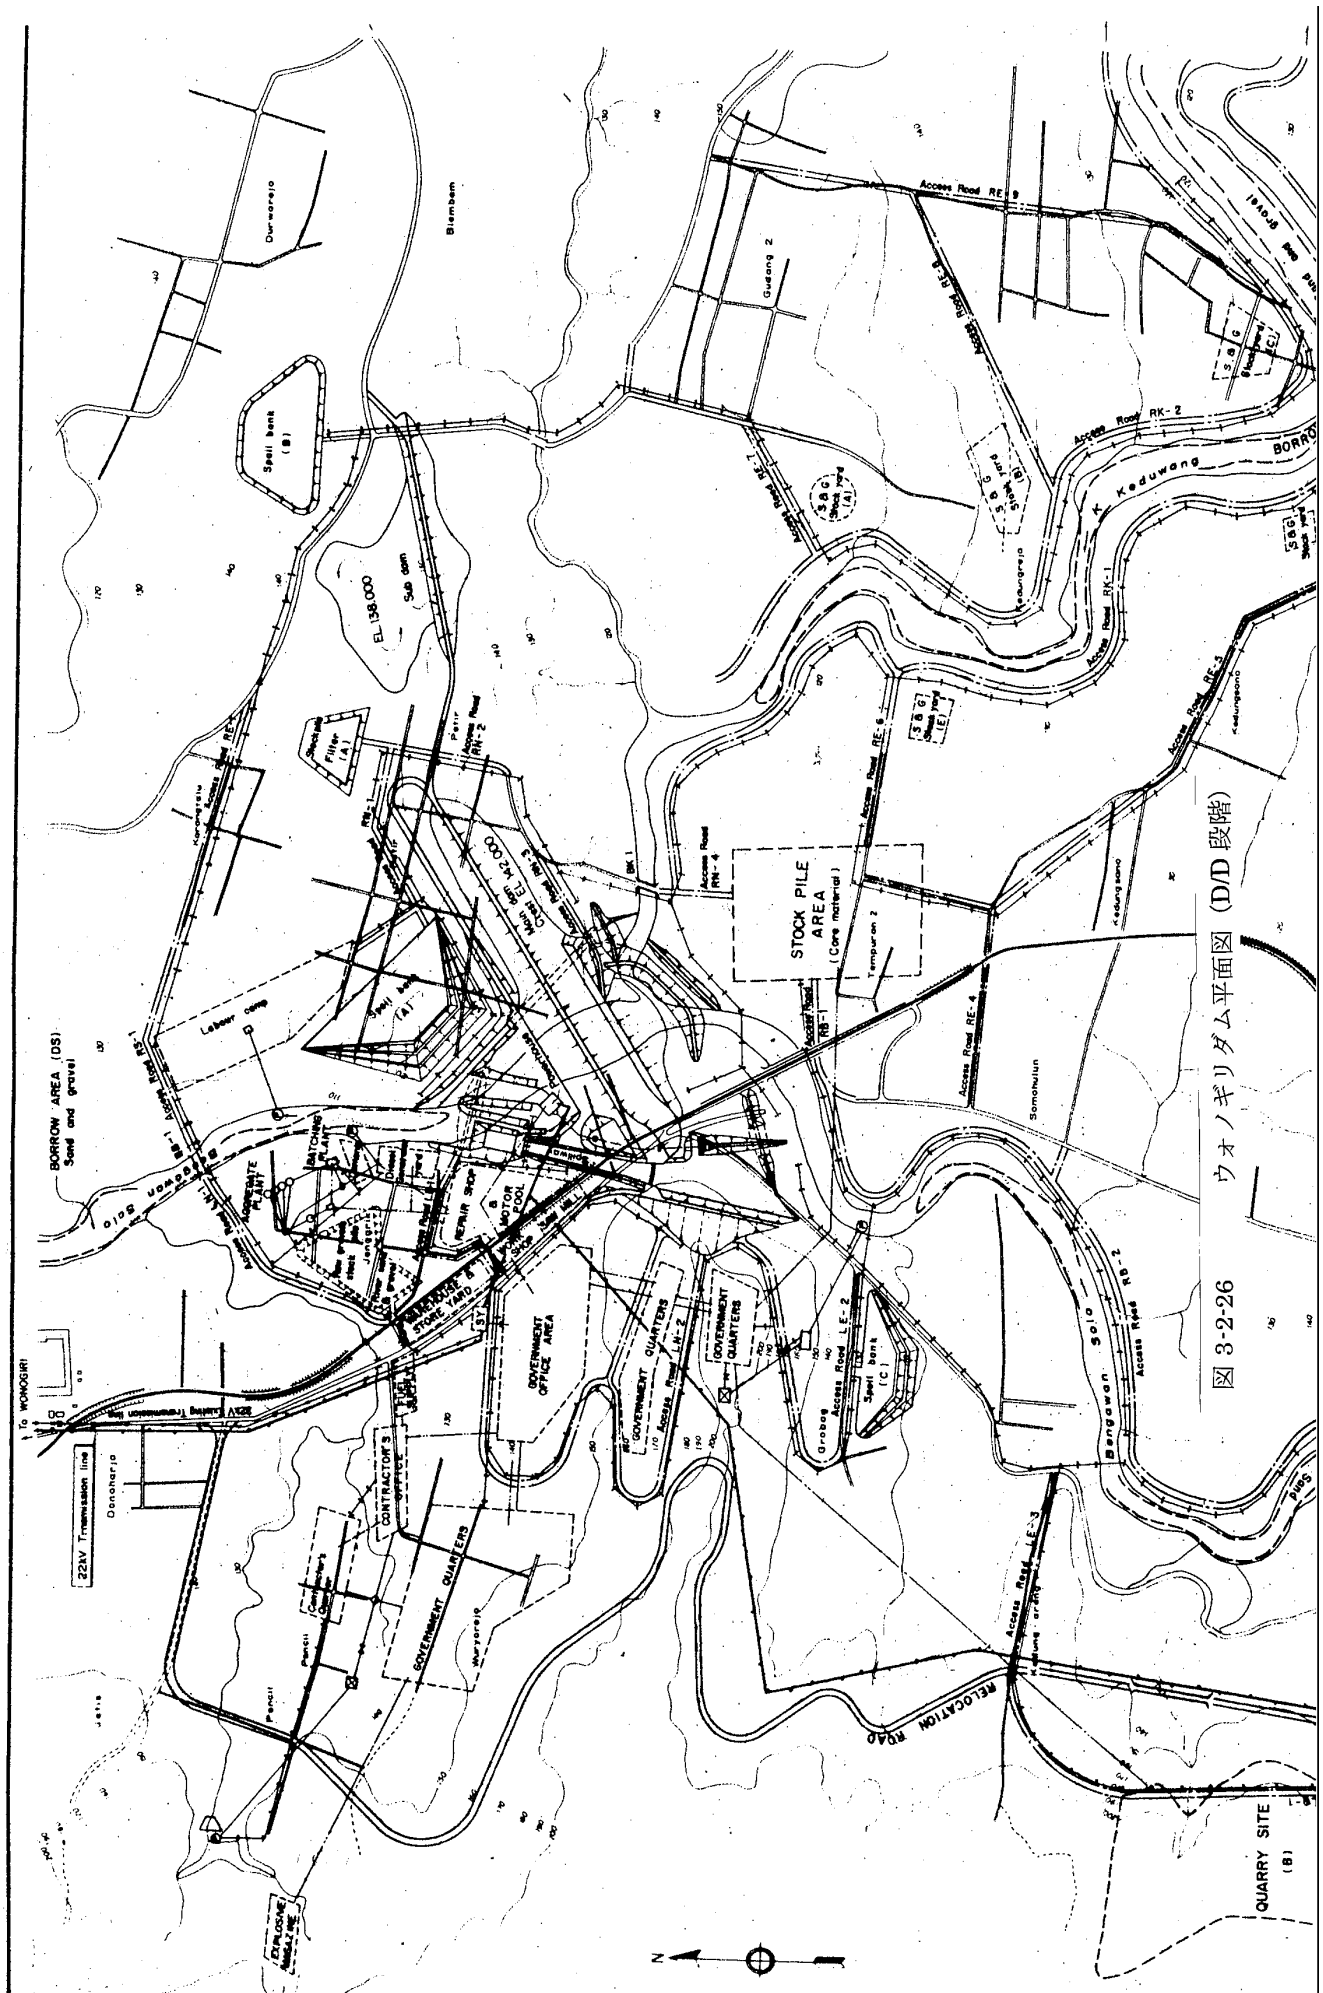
ウォノギリダム平面図 (D/D 段階)
